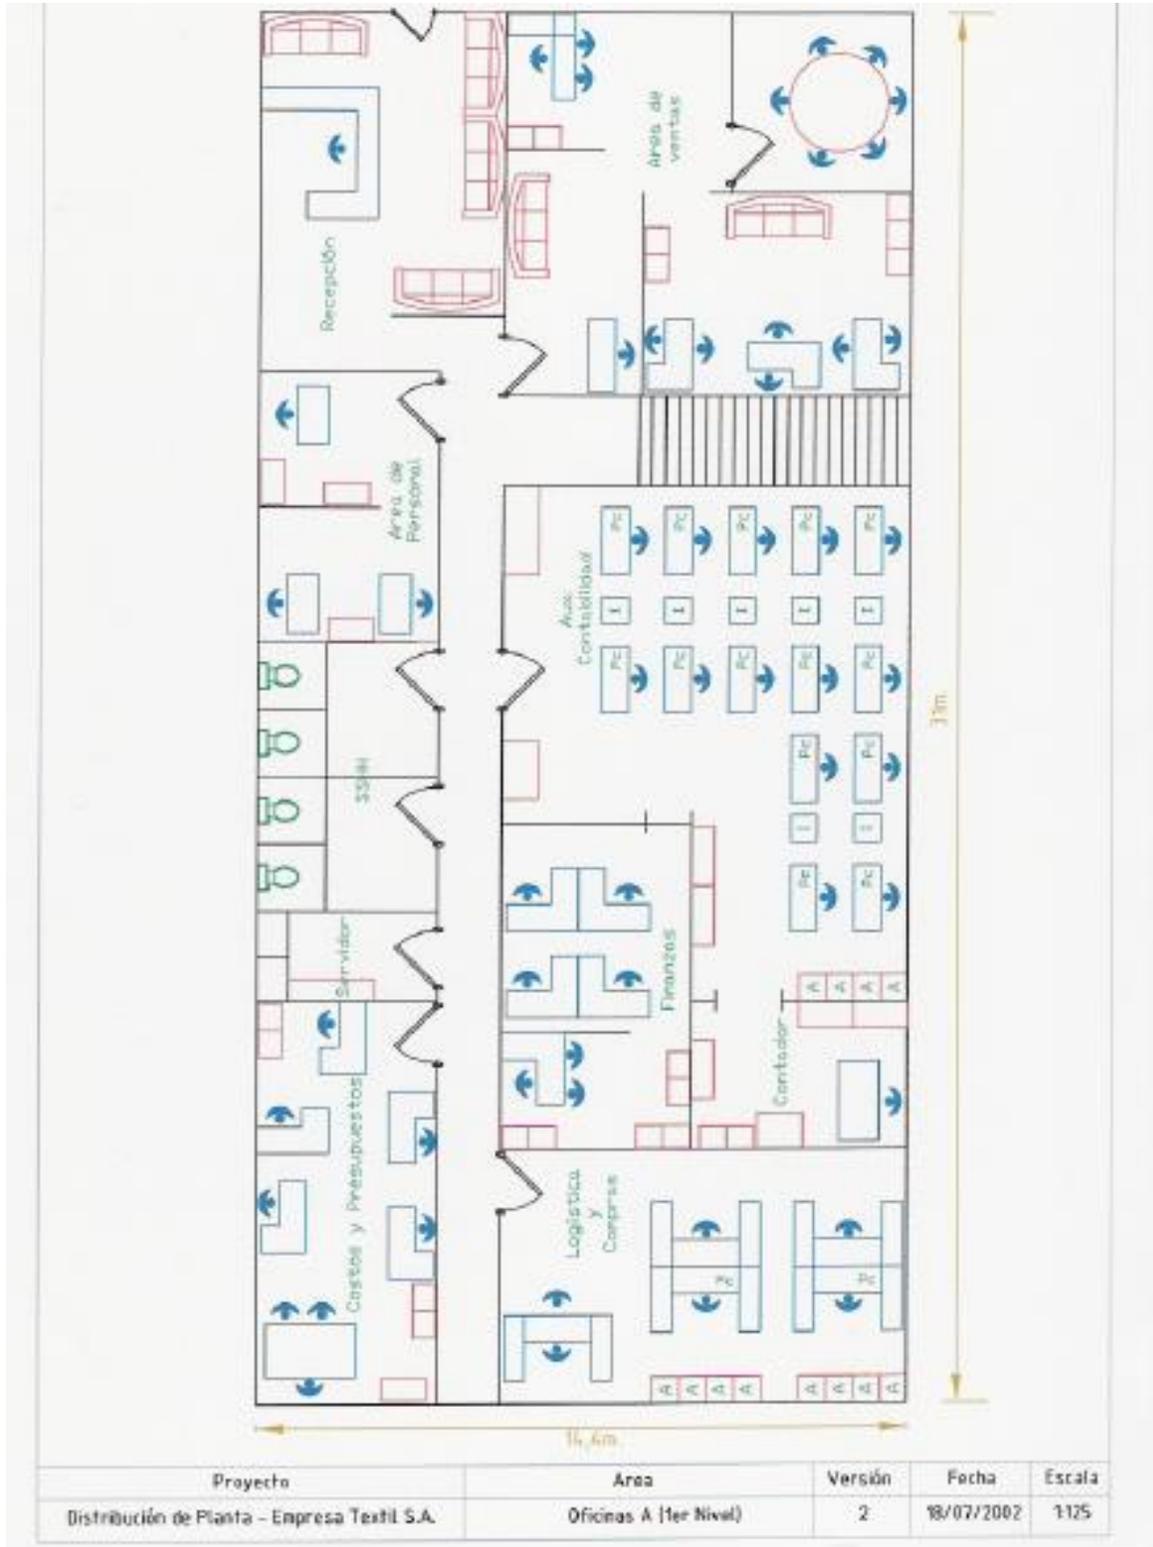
Distribución de Planta (Muñoz Cabanillas, 2004)
